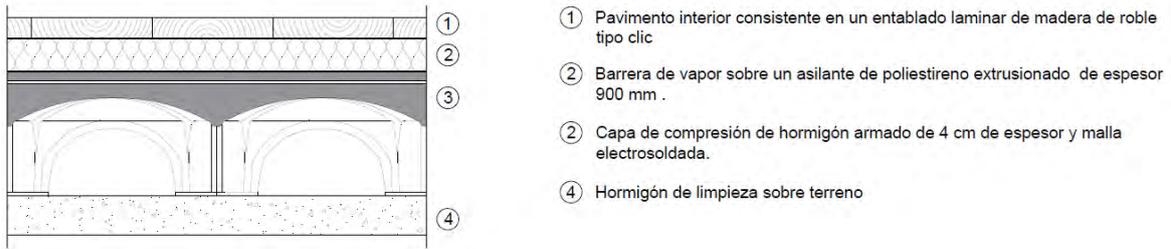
Detalle de la cimentación de la vivienda caso de estudio. Fuente: Elaboración propia
